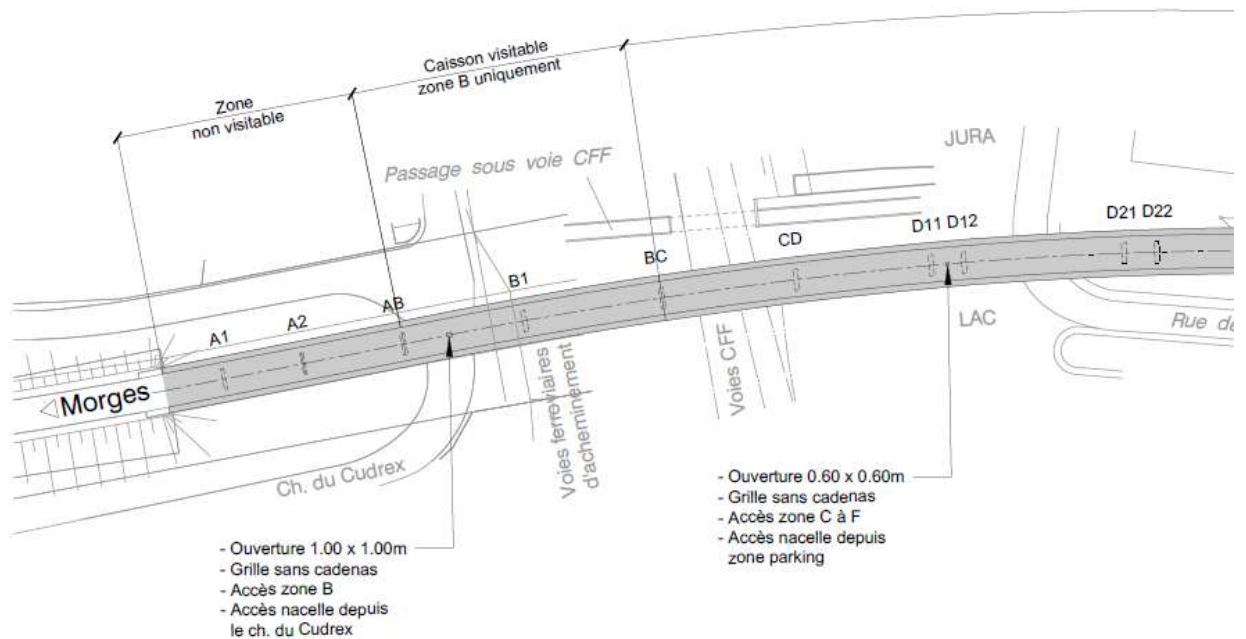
Accessibilité du caisson de la culée Morges aux piles D21/22
